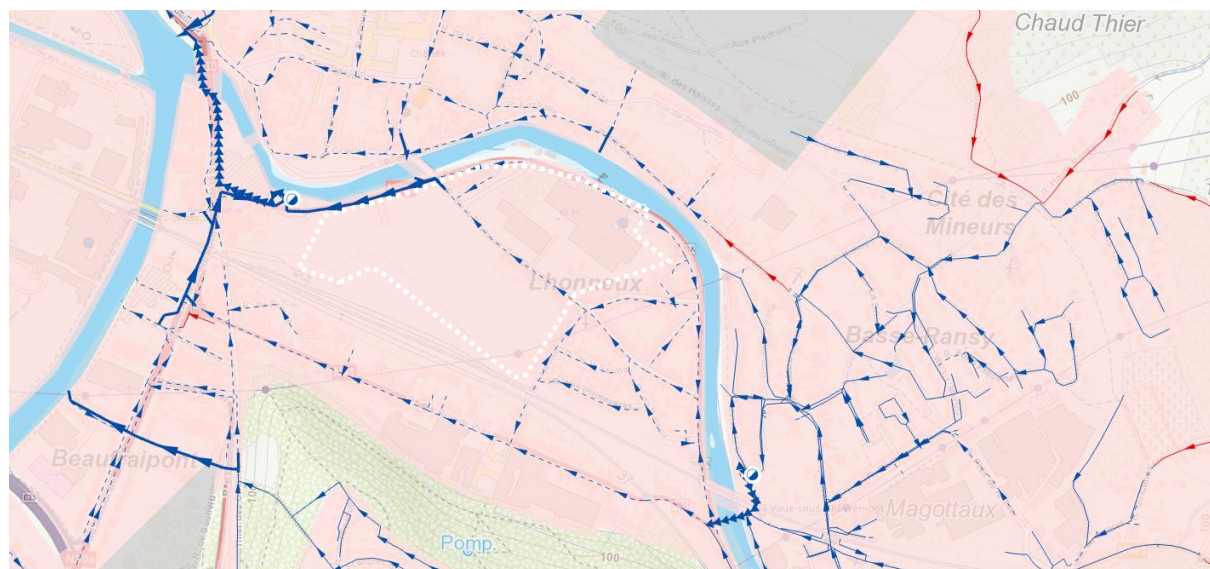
Plan d'assainissement (©SPGE, consultation le 17 juillet 2020)
